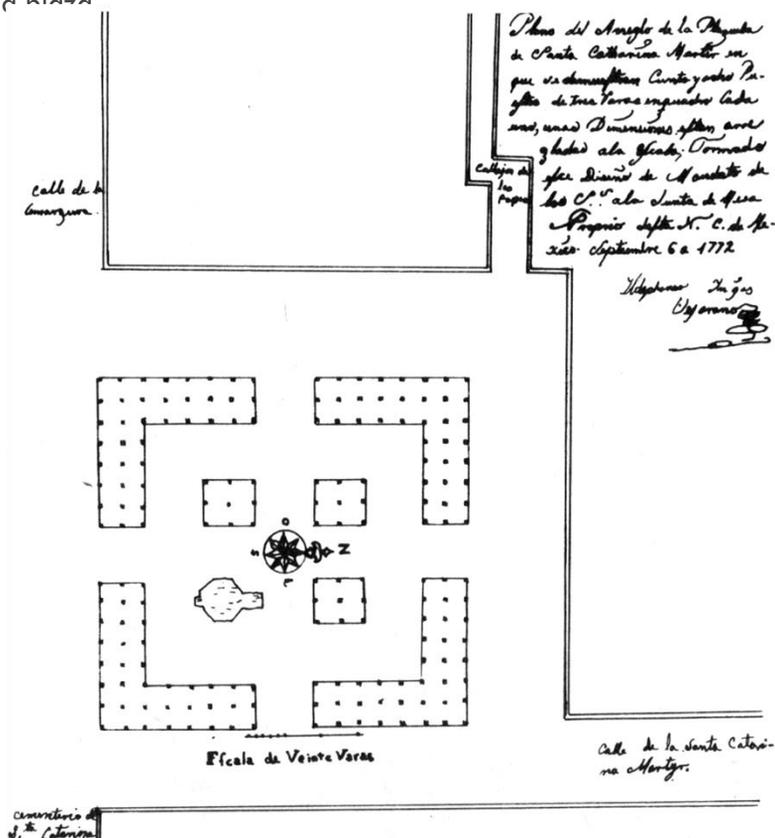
Plano del proyecto de la plaza de Santa Catarina Mártir, hecho en 1772. AHCM
